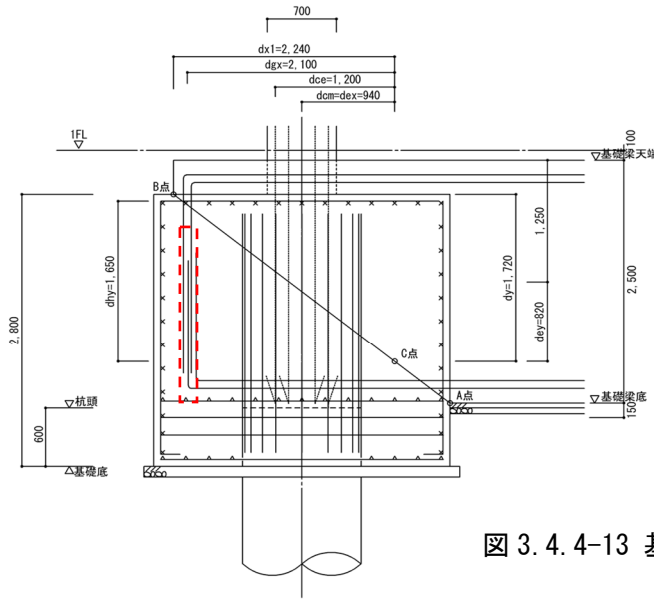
基礎・基礎梁配筋と破壊面
